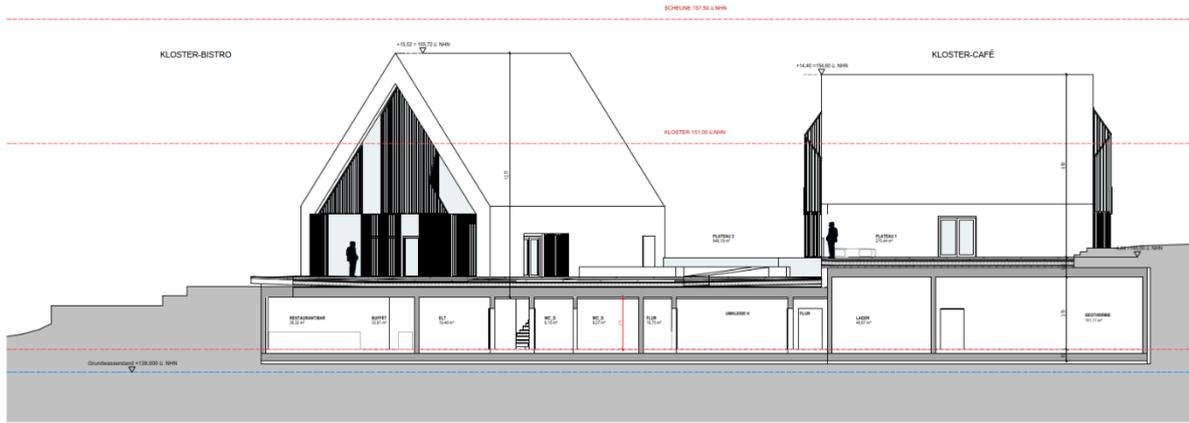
Ensemble Querschnitt D [U 1.1]
